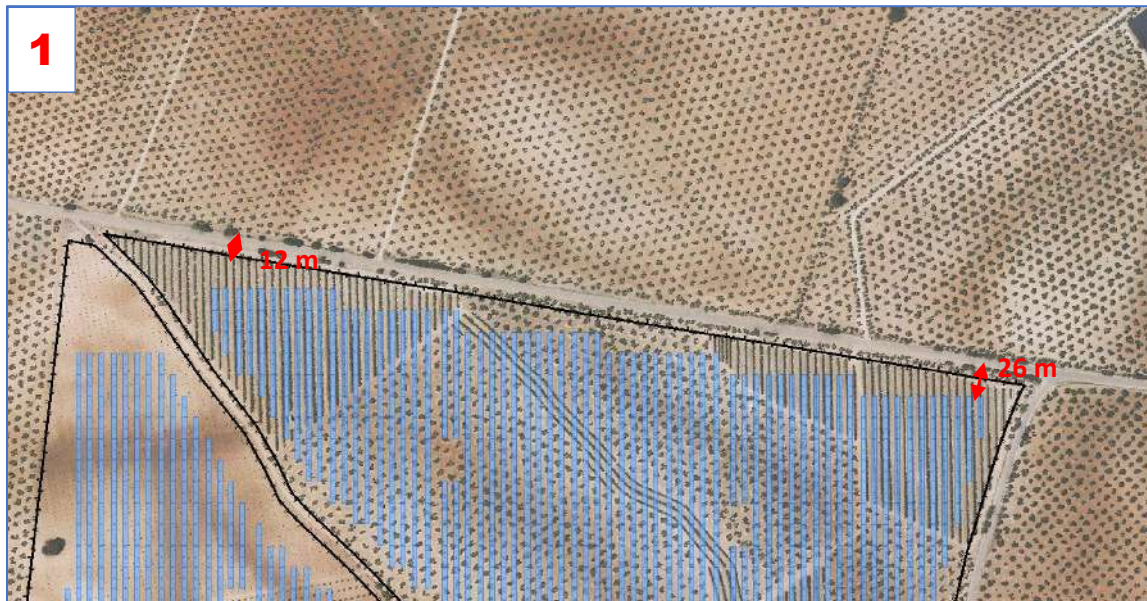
Infraestructuras en la zona de proyecto. Detalle 1. Fuente propia.
